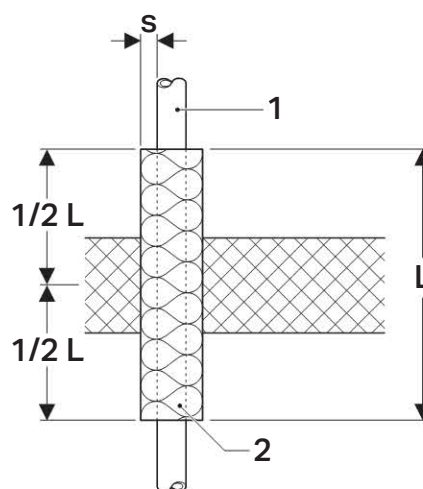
Brandschutz Geberit Mepla / PushFit: Deckendurchführung Massivdecke
